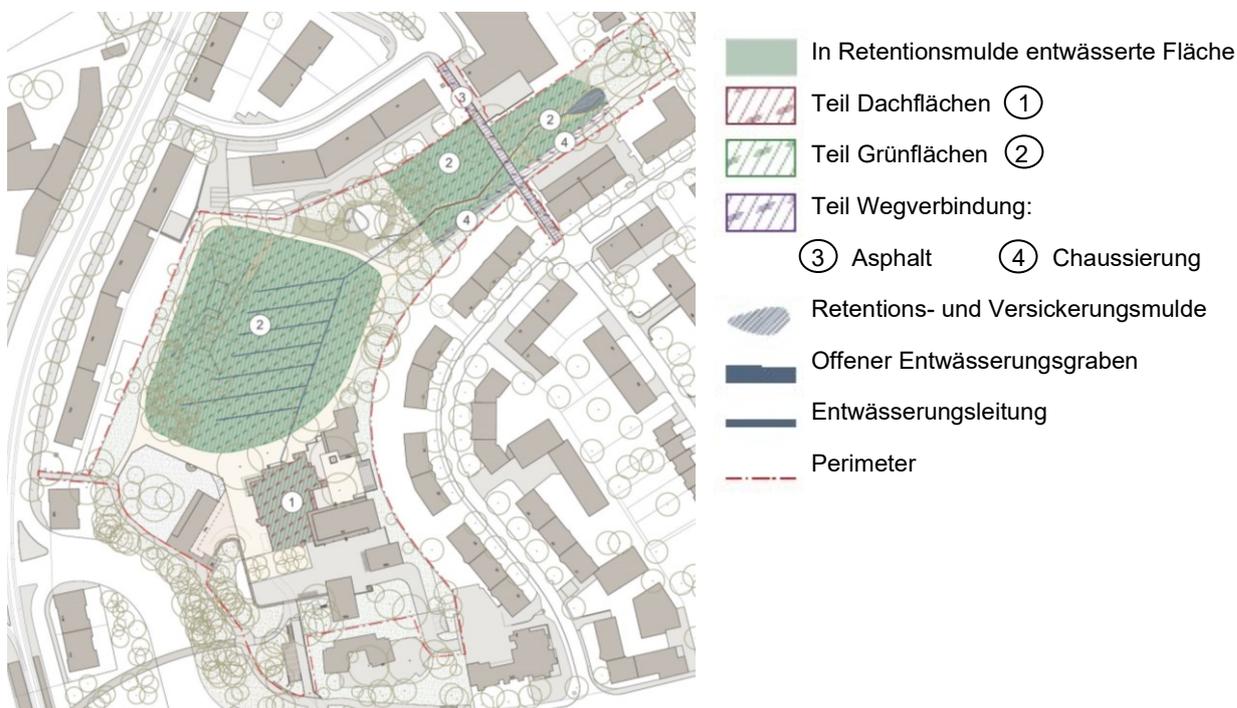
Oberflächenentwässerungsplan des Bucheggparks inkl. Retentions-/Versickerungsflächen
